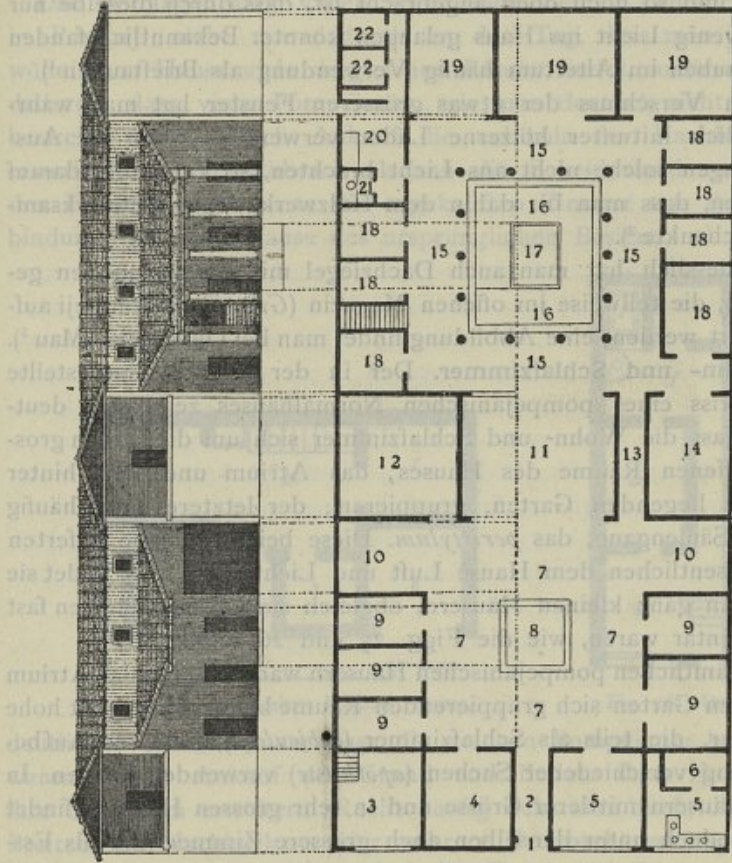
Grundriss eines pompejanischen Hauses (v. Presuhn).
